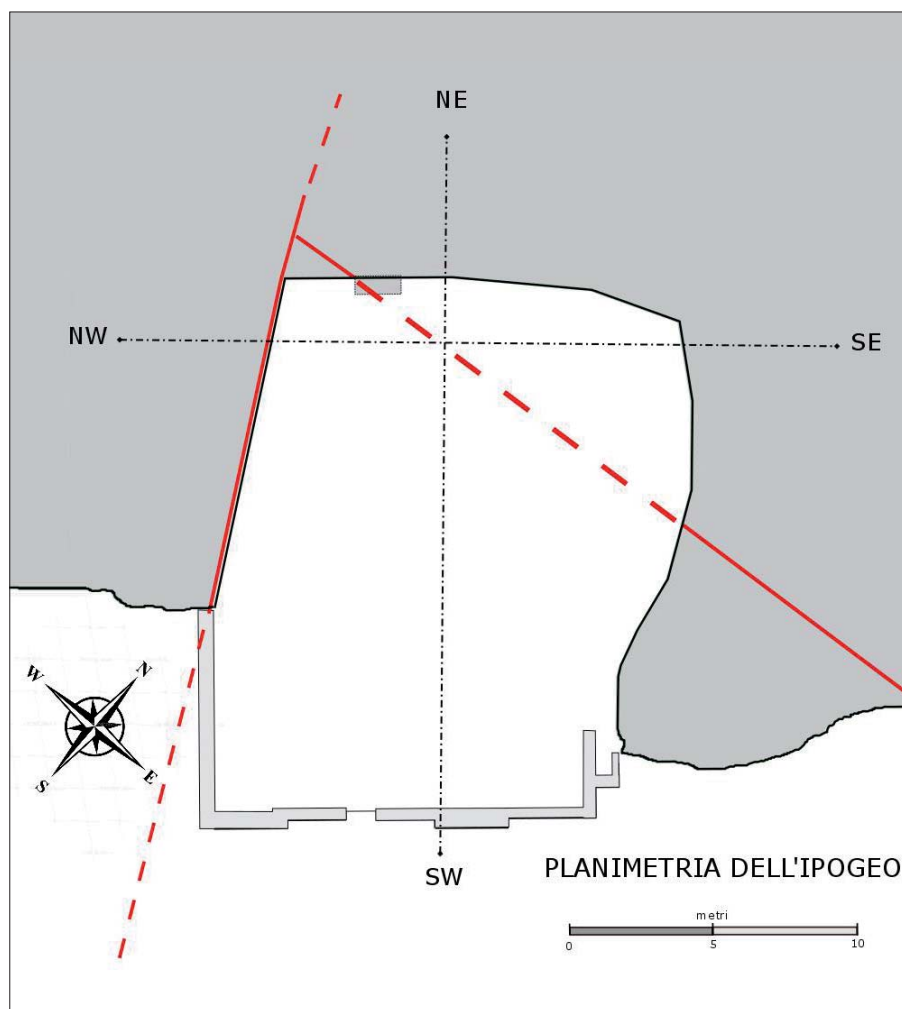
Planimetria dell'ipogeo con la traccia delle sezioni geologiche. Alla pianta sono stati sovrapposti gli elementi tettonici principali (in rosso)
